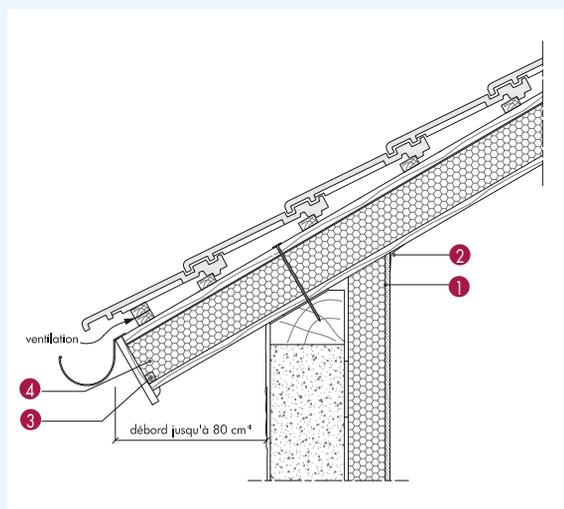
Égout en débord avec Fibratec ULTRA et Fibratec FM ULTRA Planche : planche de rive inclinée
